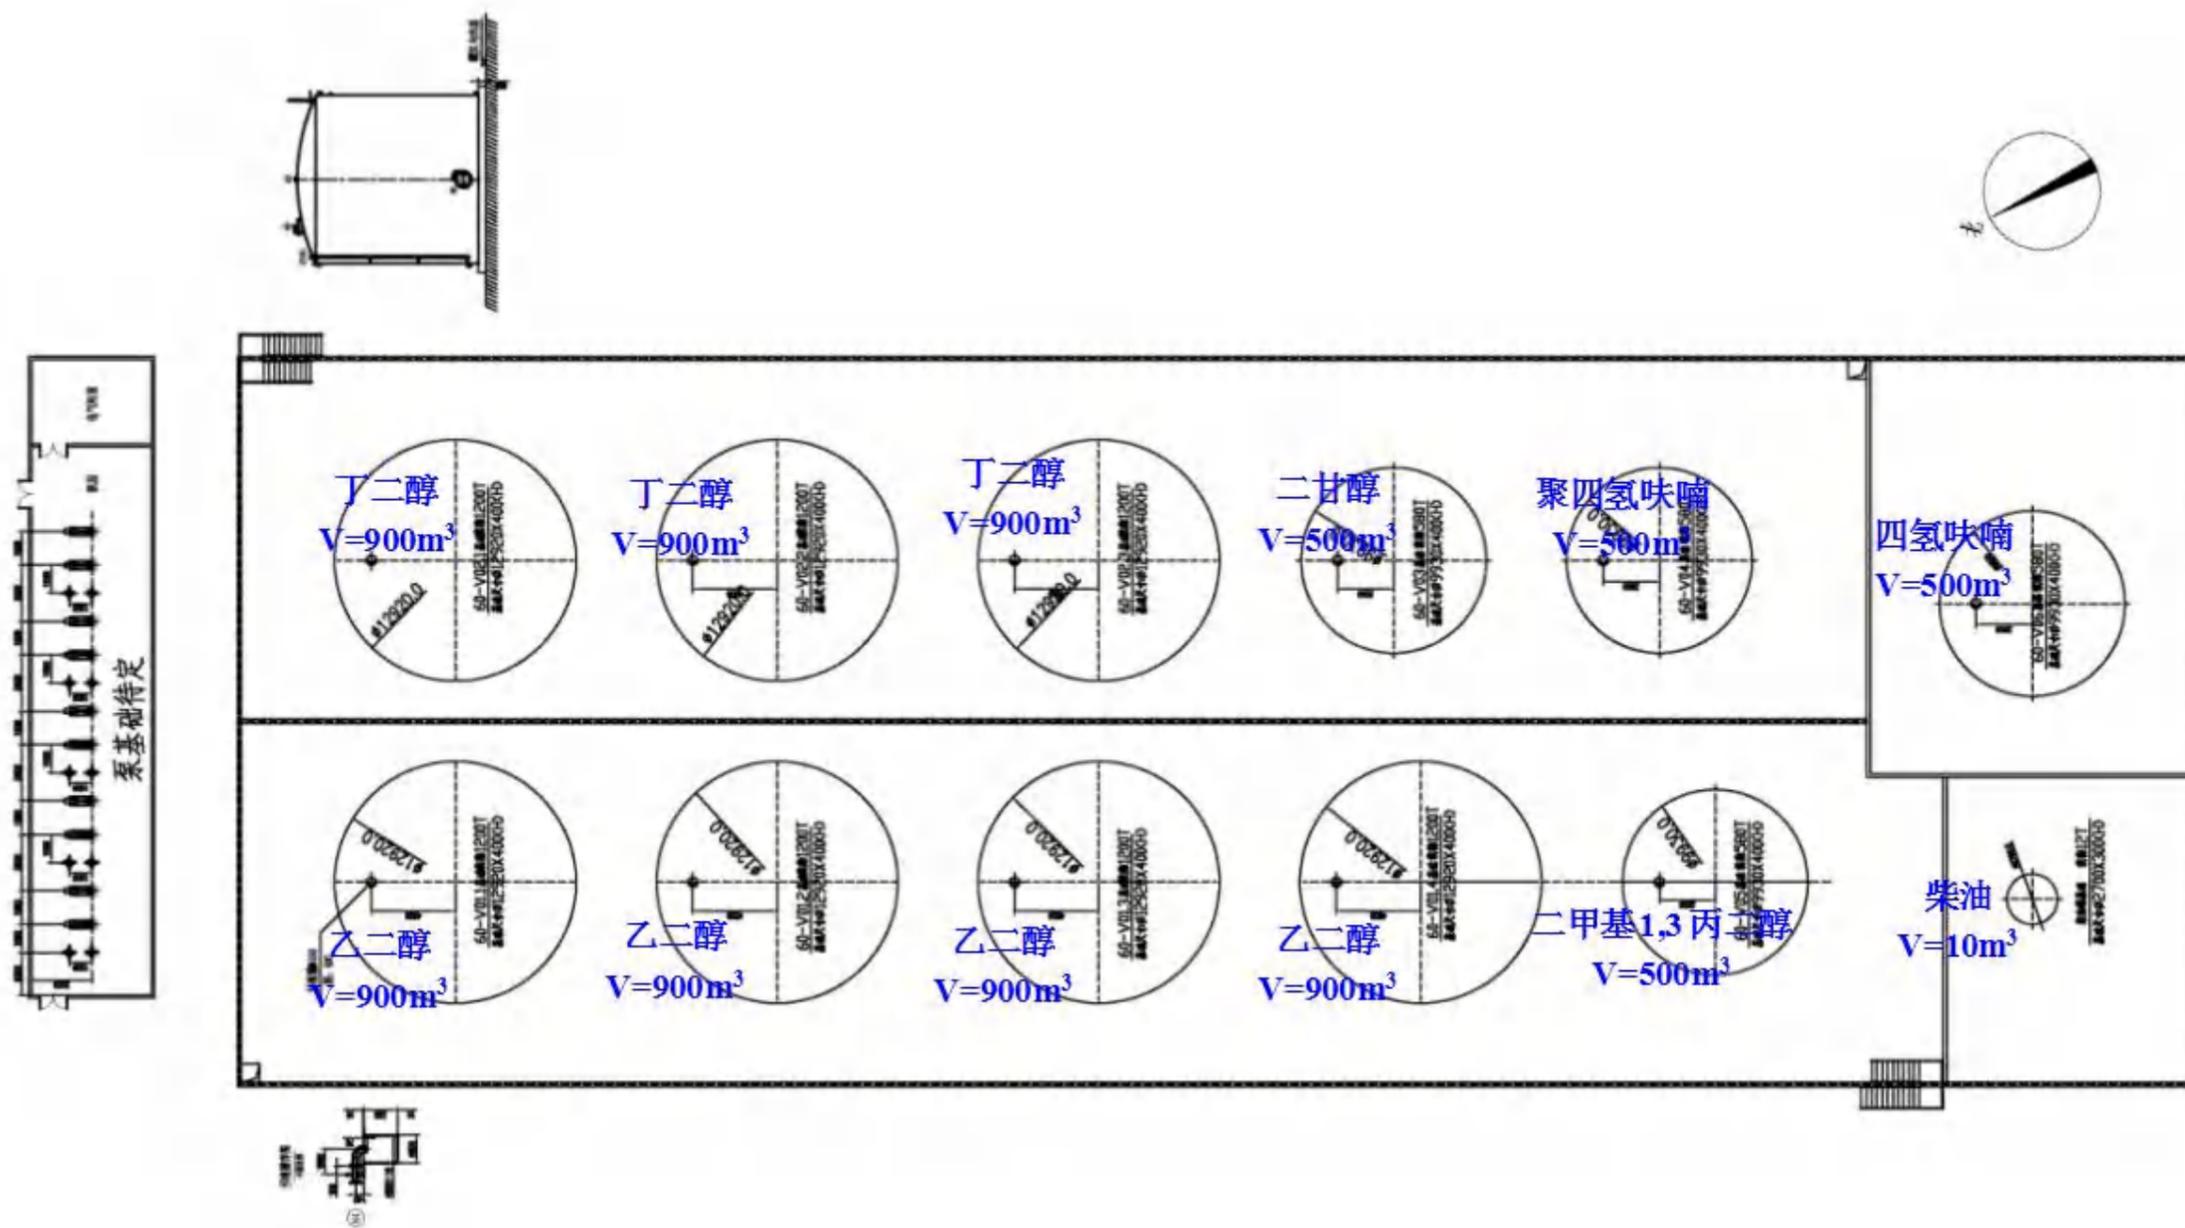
项目罐区平面布置图 (柴油暂不上)
